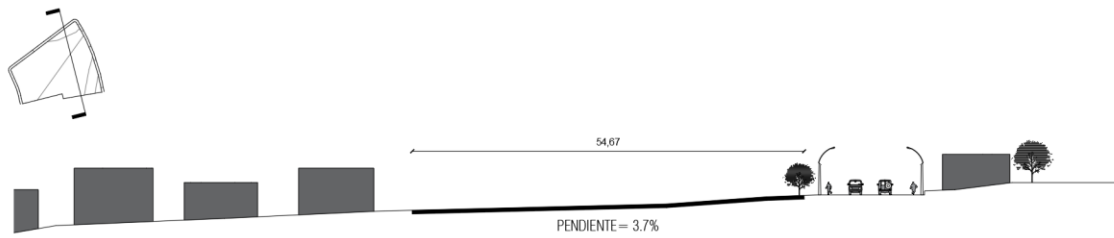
Sección transversal terreno seleccionado. Elaboración propia.
